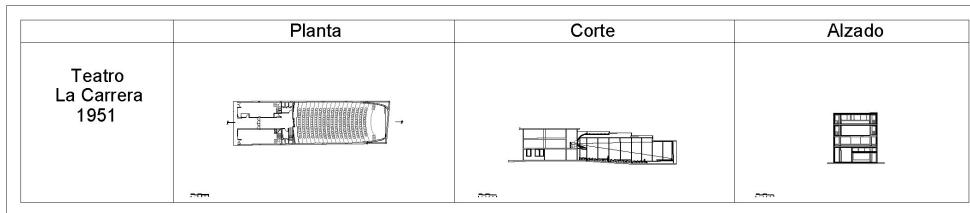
Teatro La Carrera en planta, corte y alzado.
